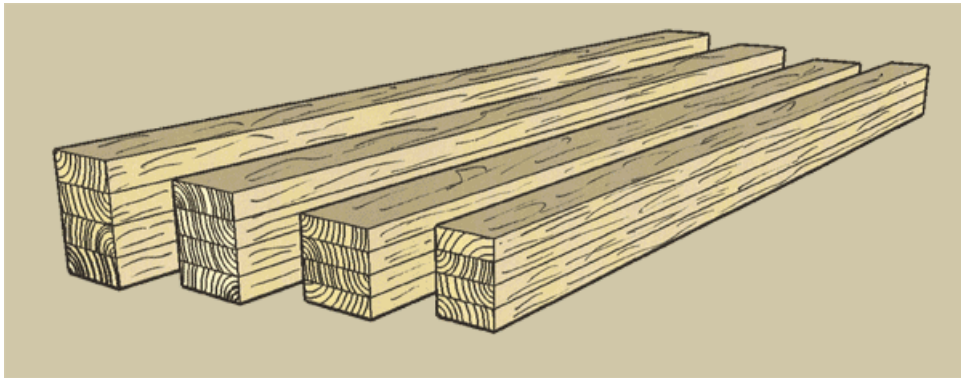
Exemples de poutres en Bois Massif Reconstitué (BMR).
